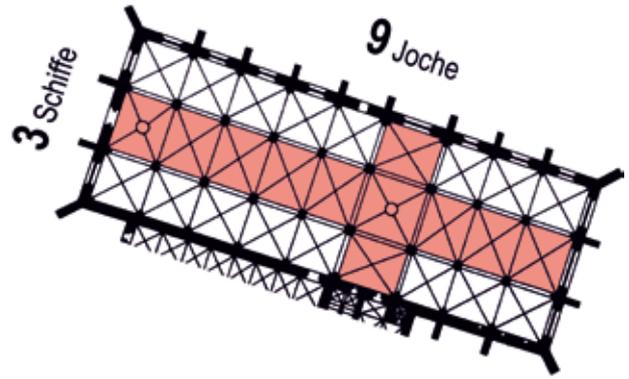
Münster Neuberg, Grundriss der dreischiffigen, neunjochigen Anlage mit integriertem Kreuz mit Zentrum Vierung.
